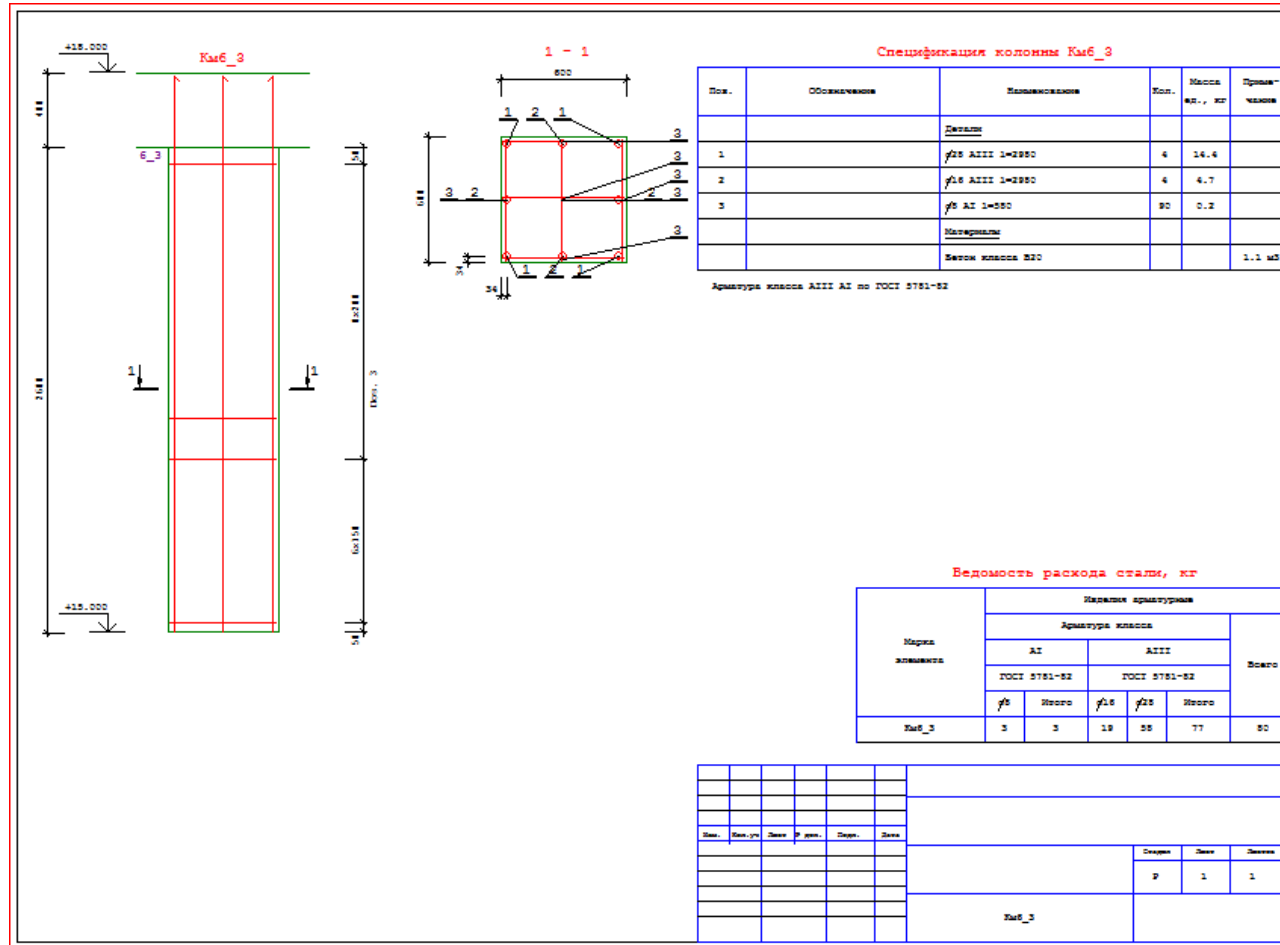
Варіант балково-плитного перекриття. Колонна К6-3. Креслення робочого проекту
